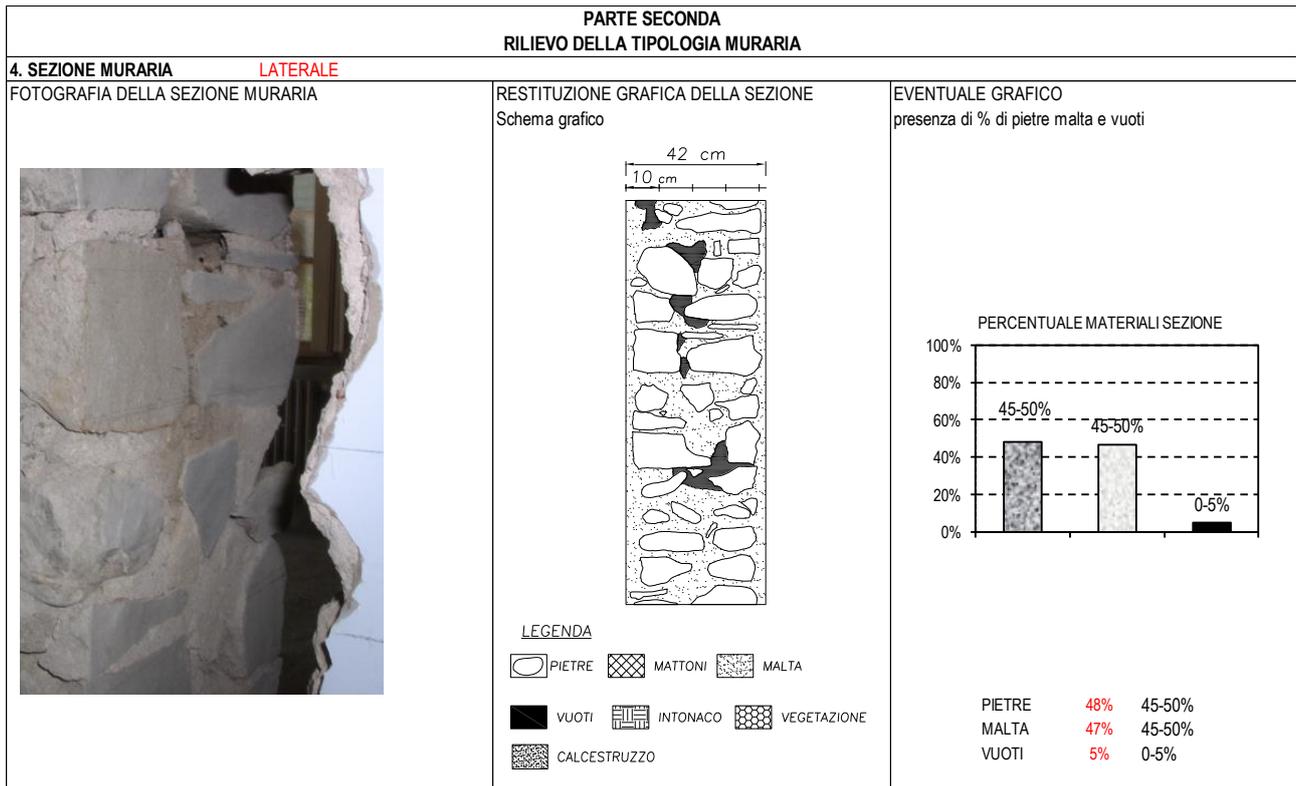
Fotografia, restituzione grafica e grafico della sezione muraria.
